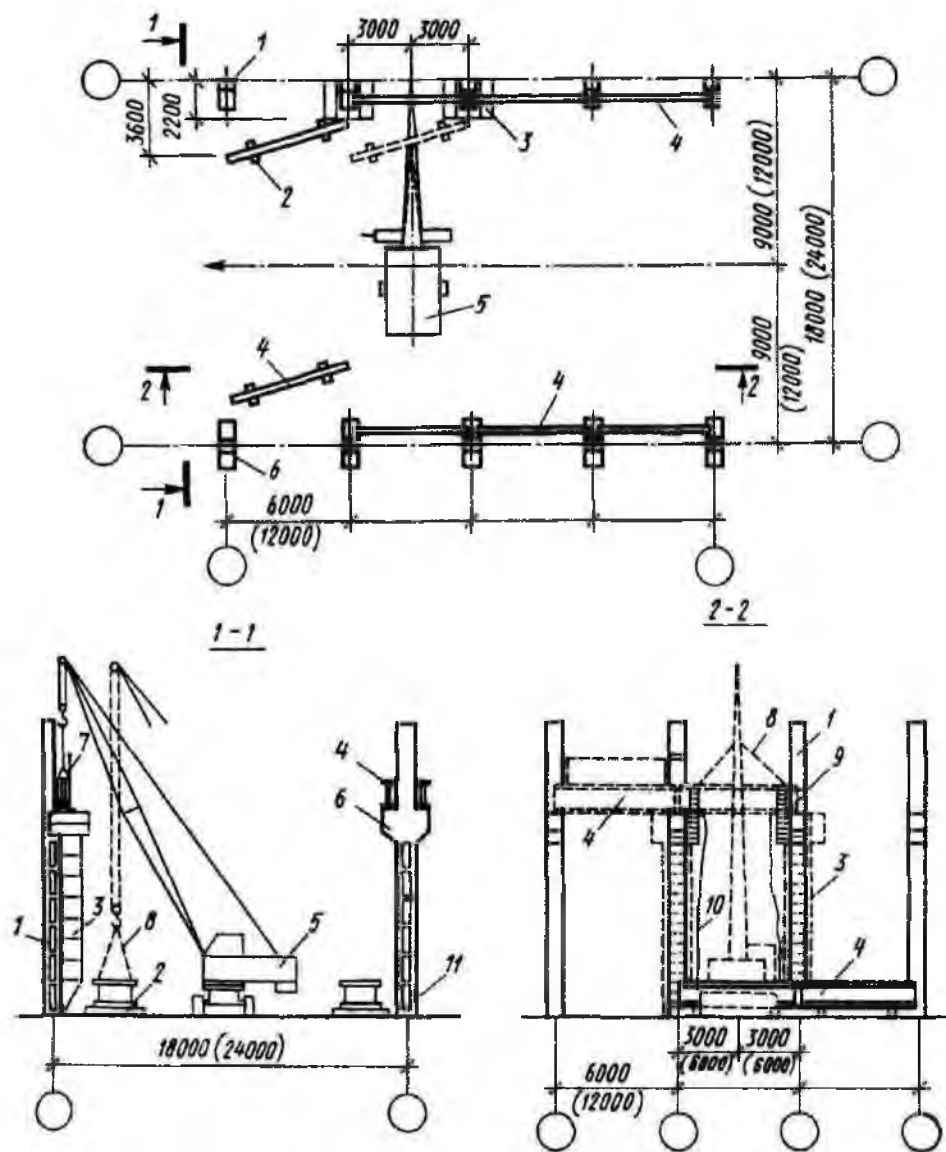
Схема установки подкрановых балок пролетом 6 и 12 м:
